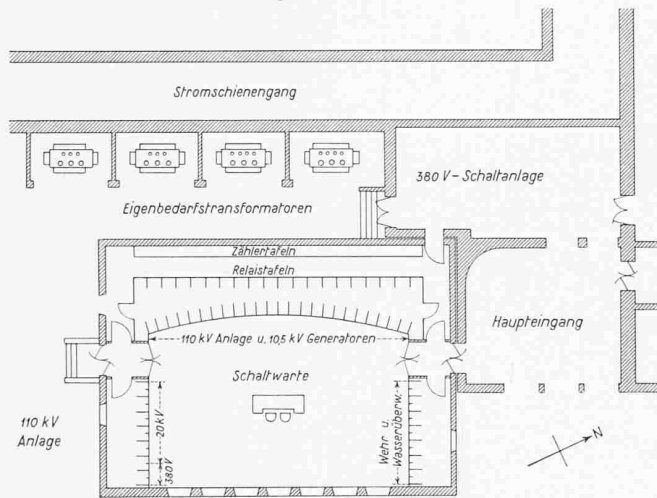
Grundriss der Schaltwarte, Masstab 1:400
